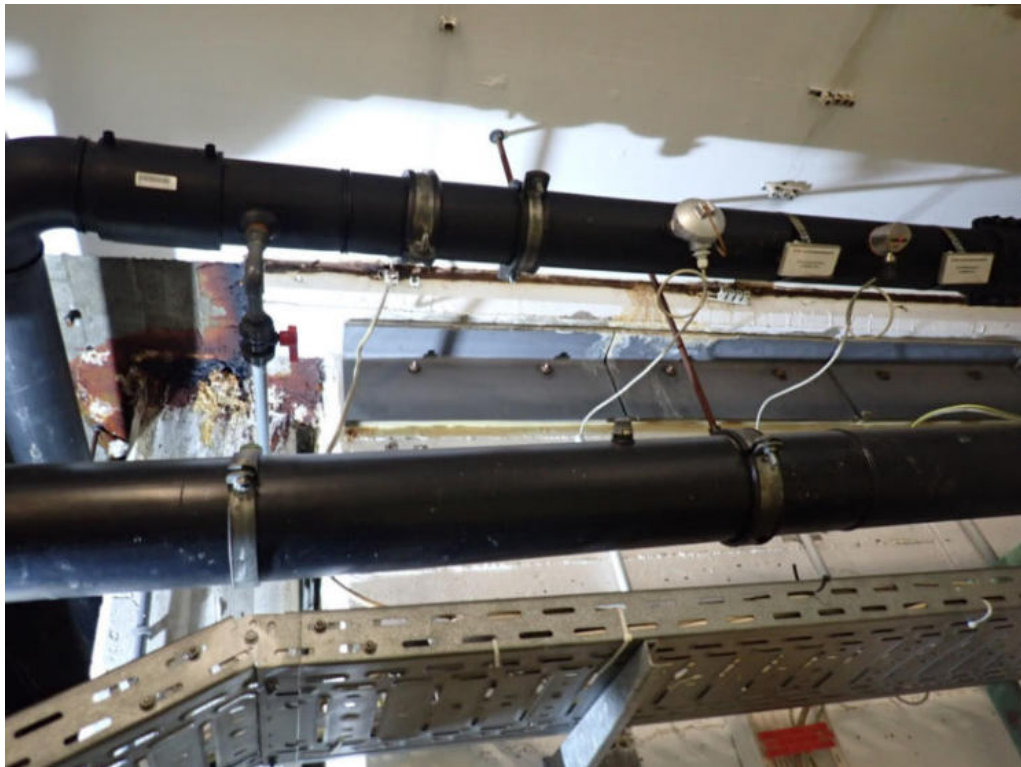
Untersuchungsbereich 23 im Erdgeschoss/ Technikbereich – Stahlwinkel
